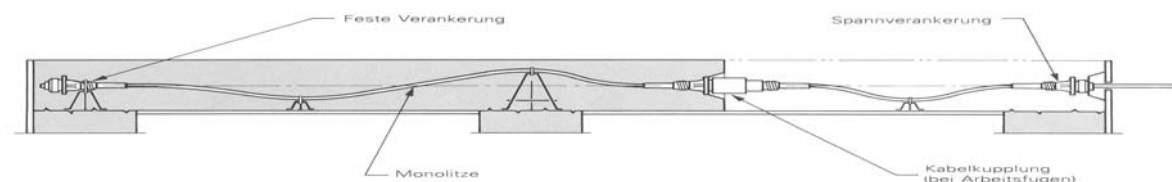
Spannbeton: - vor- od. nachgespannte Spannglieder (Litzen, Drähte) im Verbund
